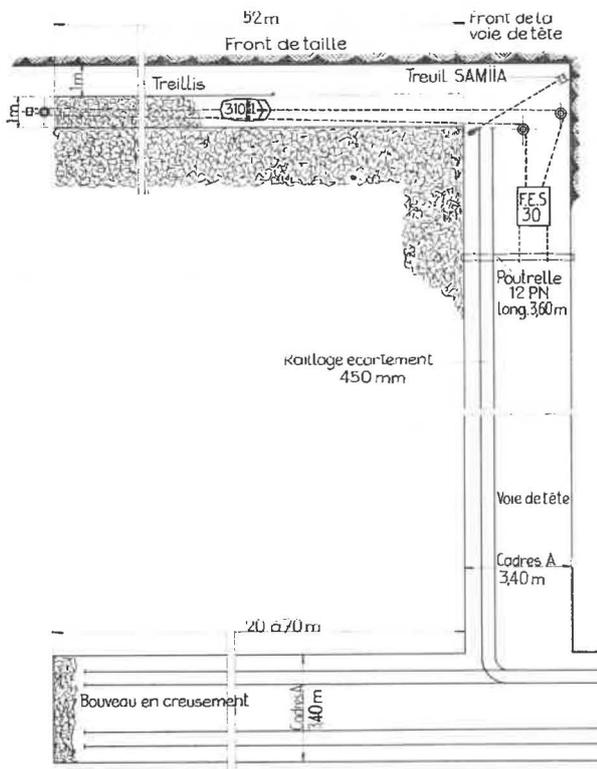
Remblayage en taille par scraper (les terres proviennent du bosseyement de la voie de tête). Disposition générale du chantier. Havée de 50 m en cours de remblayage.
